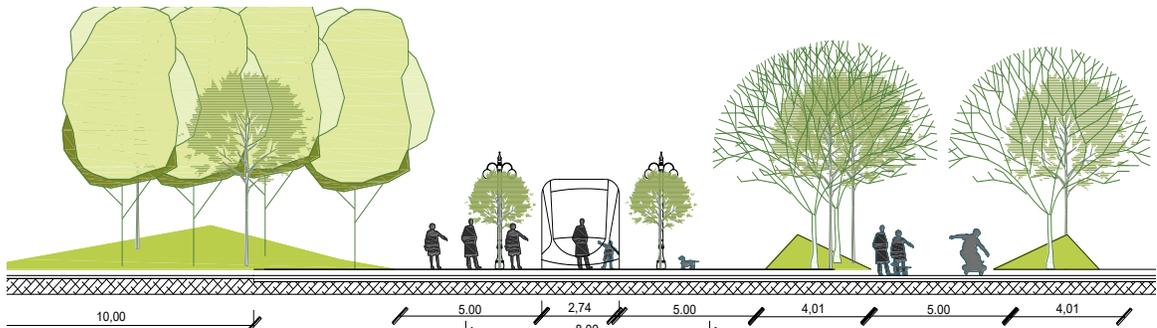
Perfil Transversal de Propuesta de Implementación del SITM.
